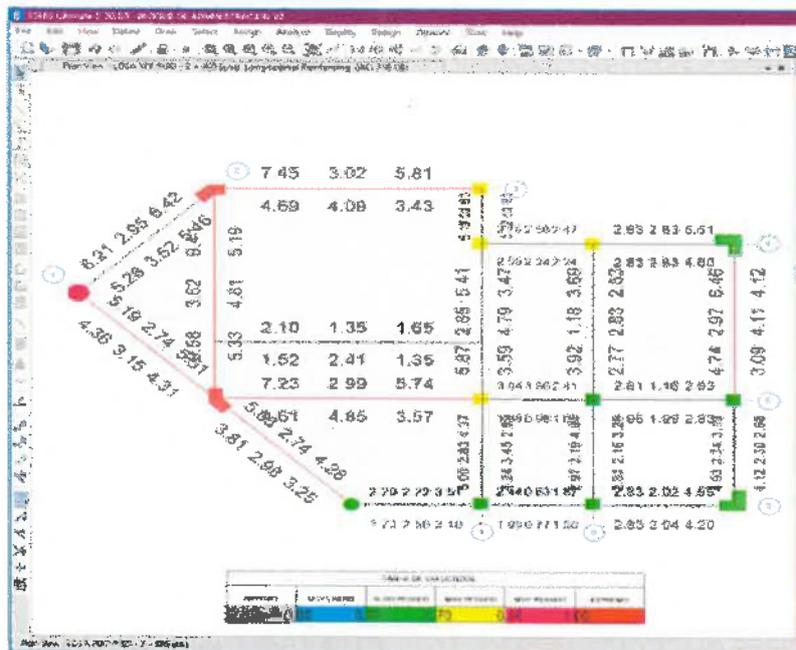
Distribución de refuerzo longitudinal por flexión más torsión en vigas del 1er nivel.
